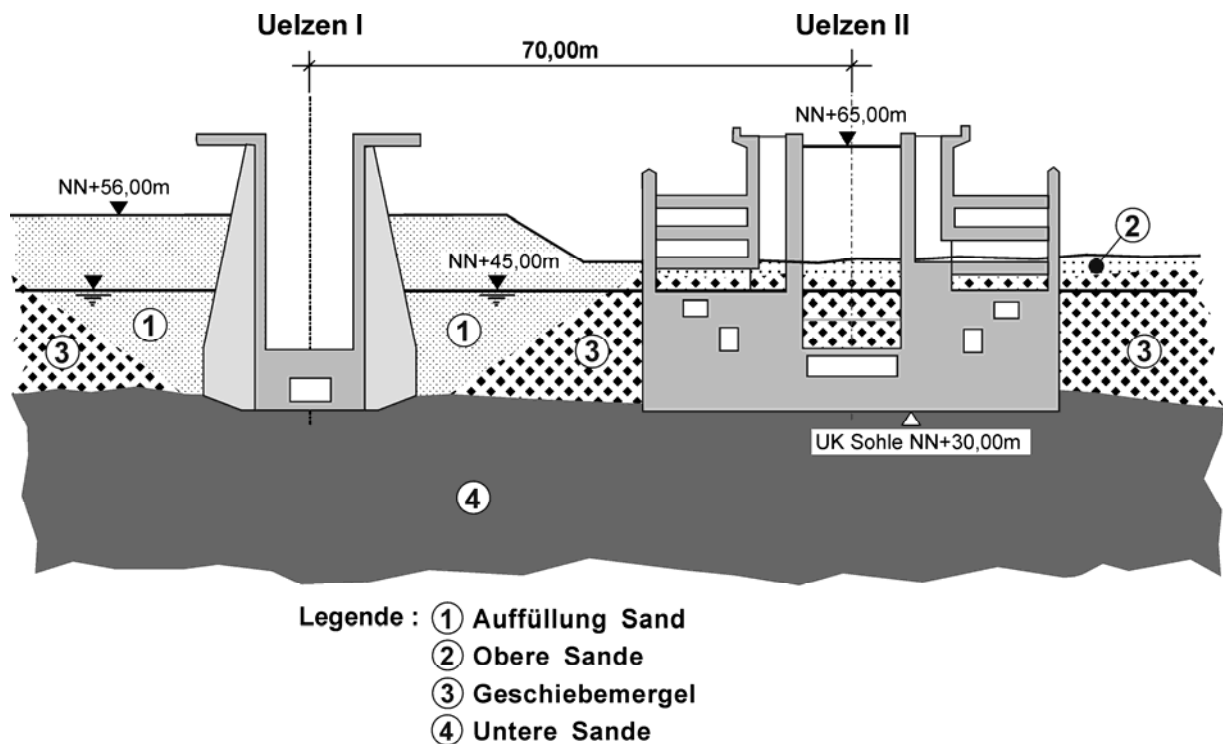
Baugrundaufbau im Querschnitt mit bestehender und neuer Schleuse
